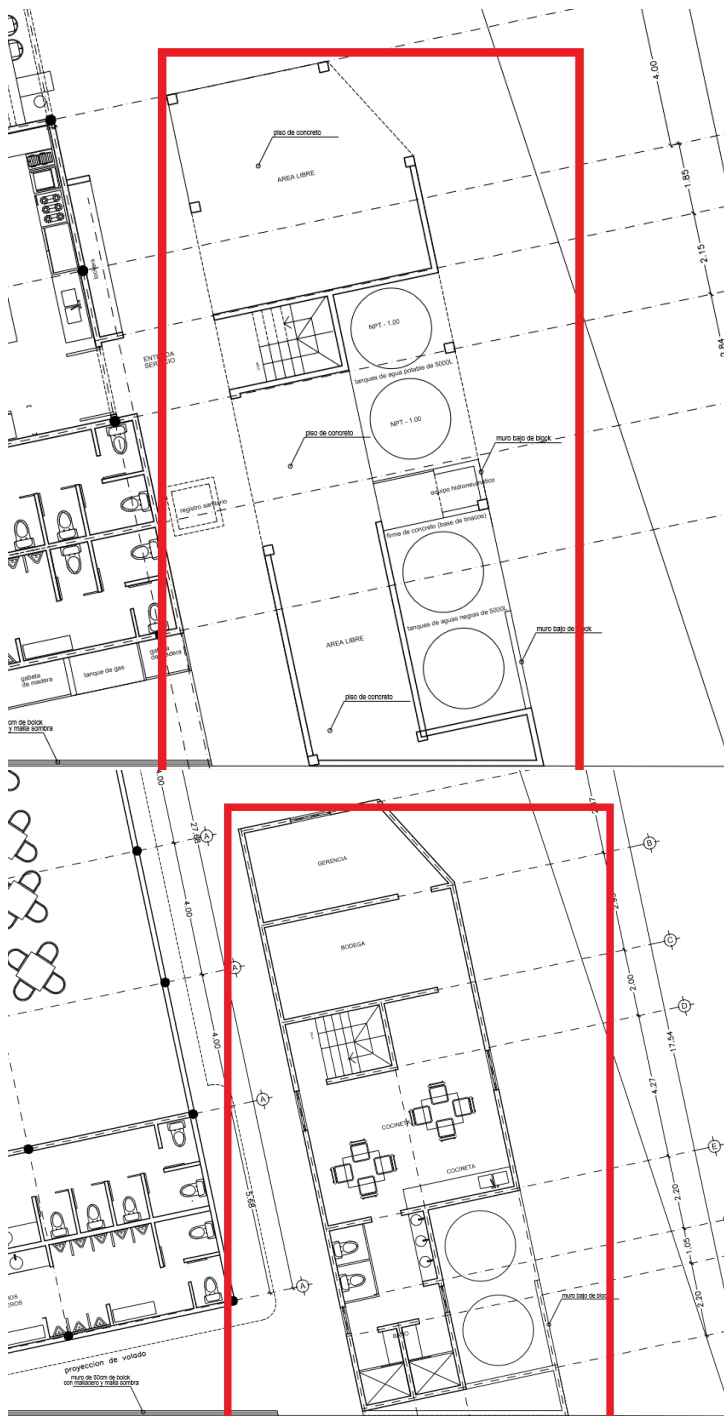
extracto del plano de conjunto de la planta baja de las ampliaciones.
